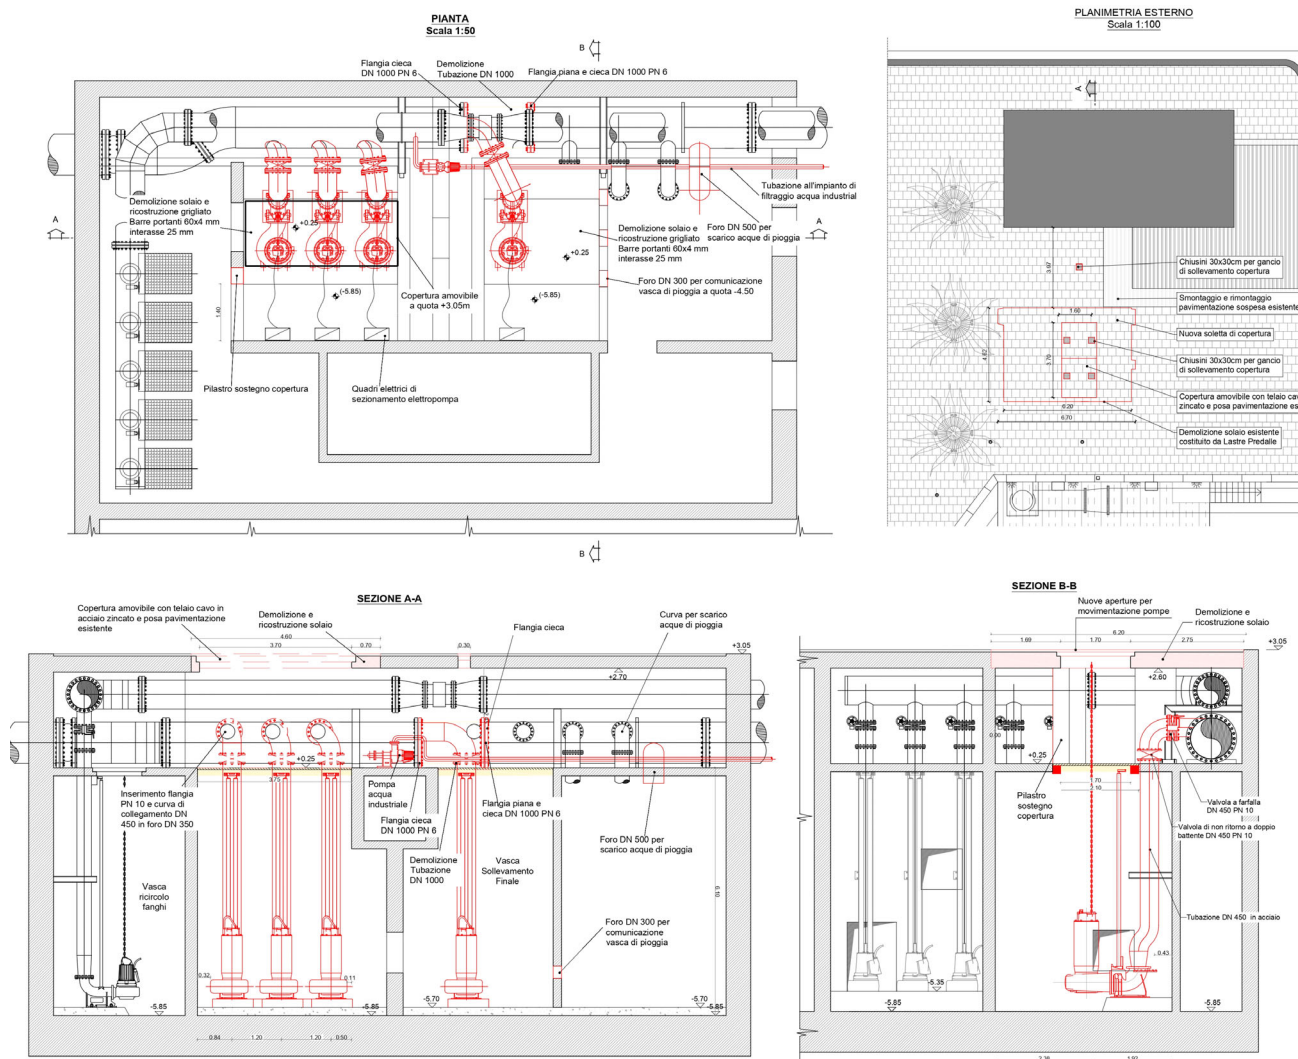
Layout dell'impianto di sollevamento finale (Fonte: Depuratore Darsena, impianto di sollevamento finale e opere migliorative – Progetto esecutivo – Relazione idraulica; IRETI, Giugno 2012).
